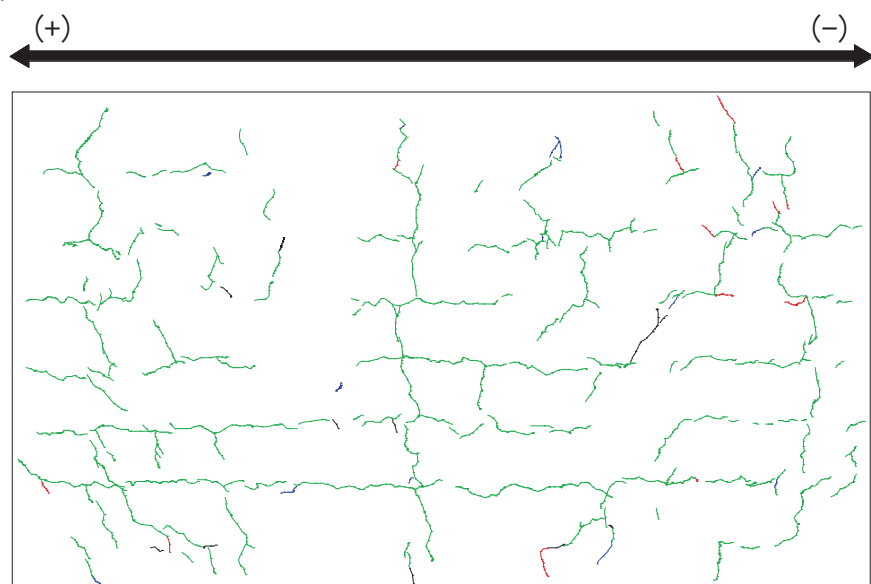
(3) 乾燥試験体 [2] 1/5000rad. におけるひび割れ図
